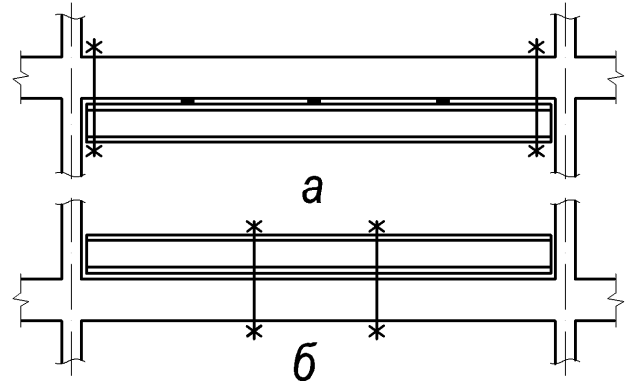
Підсилення балки елементами, що розвантажують: а – під перекриттям; б – над перекриттям
